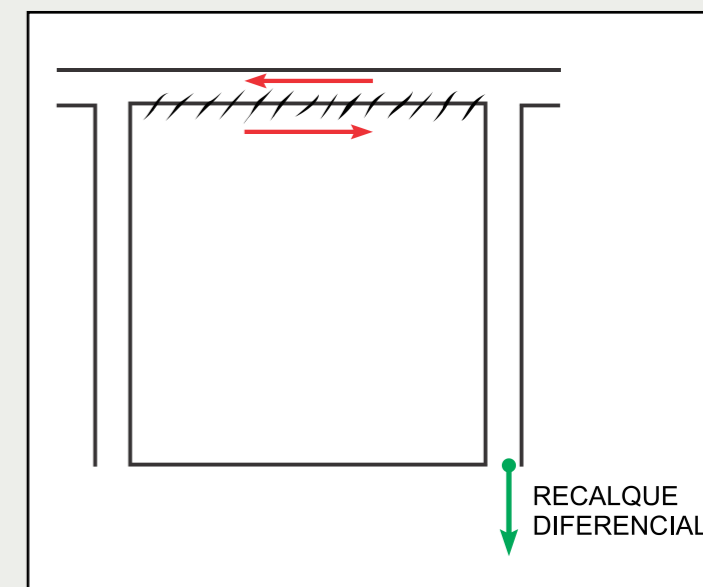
Tensões tangenciais entre viga e parede (fissuras curtas à 45°).
